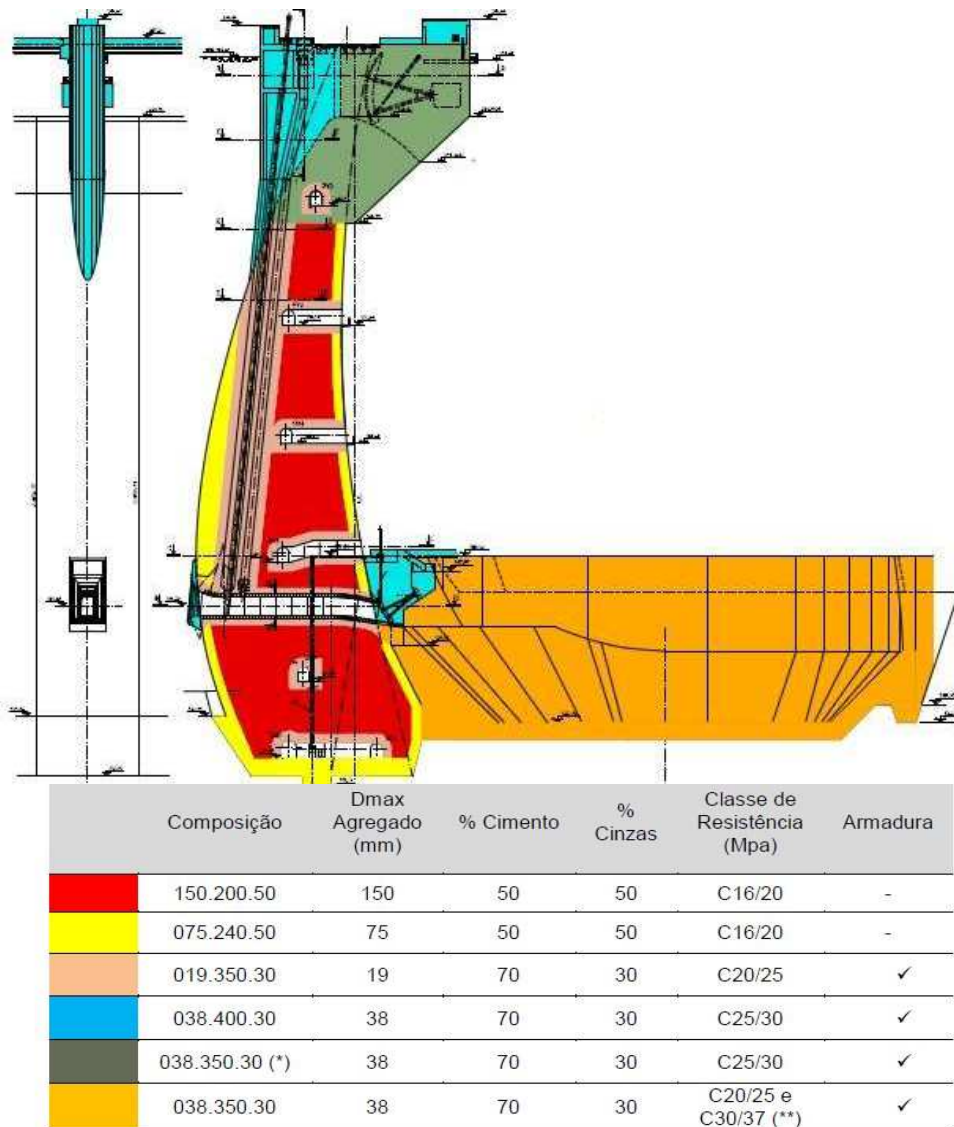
Tipos de betão a aplicar nos diferentes elementos da barragem – corte transversal (Sousa, 2011)
